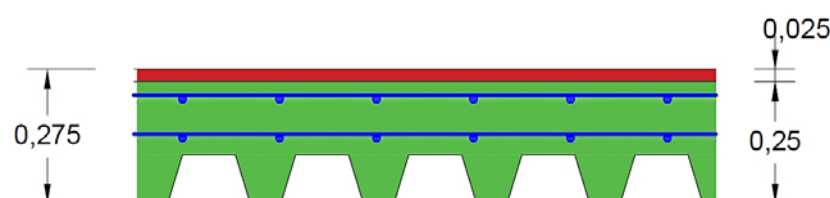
Condiciones de adherencia para las barras de armadura pasiva de la losa. Elaboración propia con AutoCAD.
